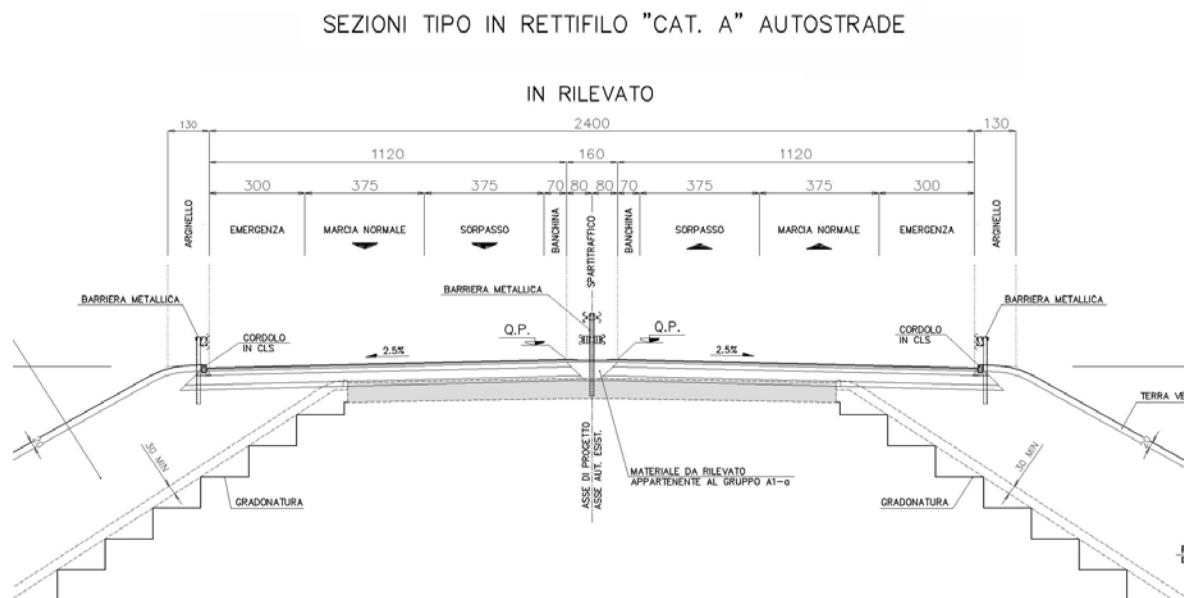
Sezione tipo di progetto (adeguamento SS1 Aurelia)
